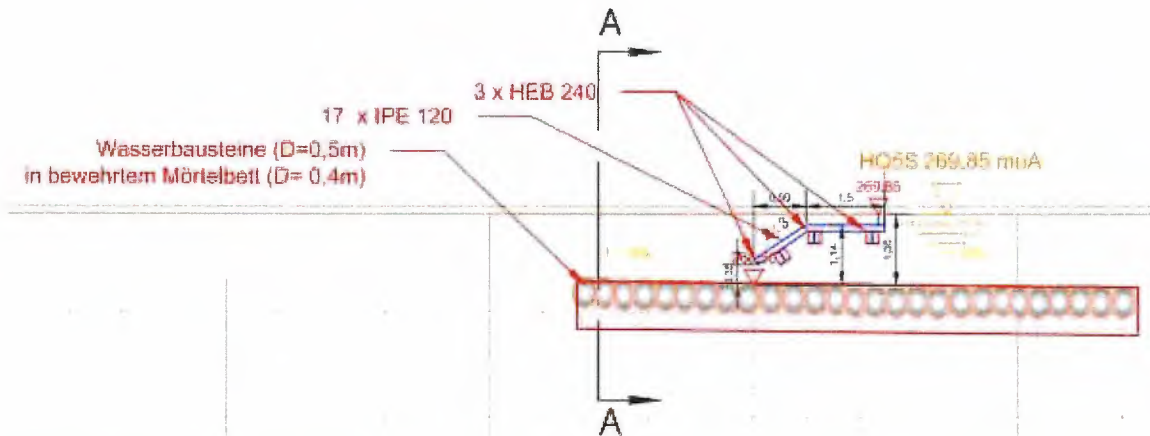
Wildholzrechen an der Stauwurzel; aus Plan 12.6
